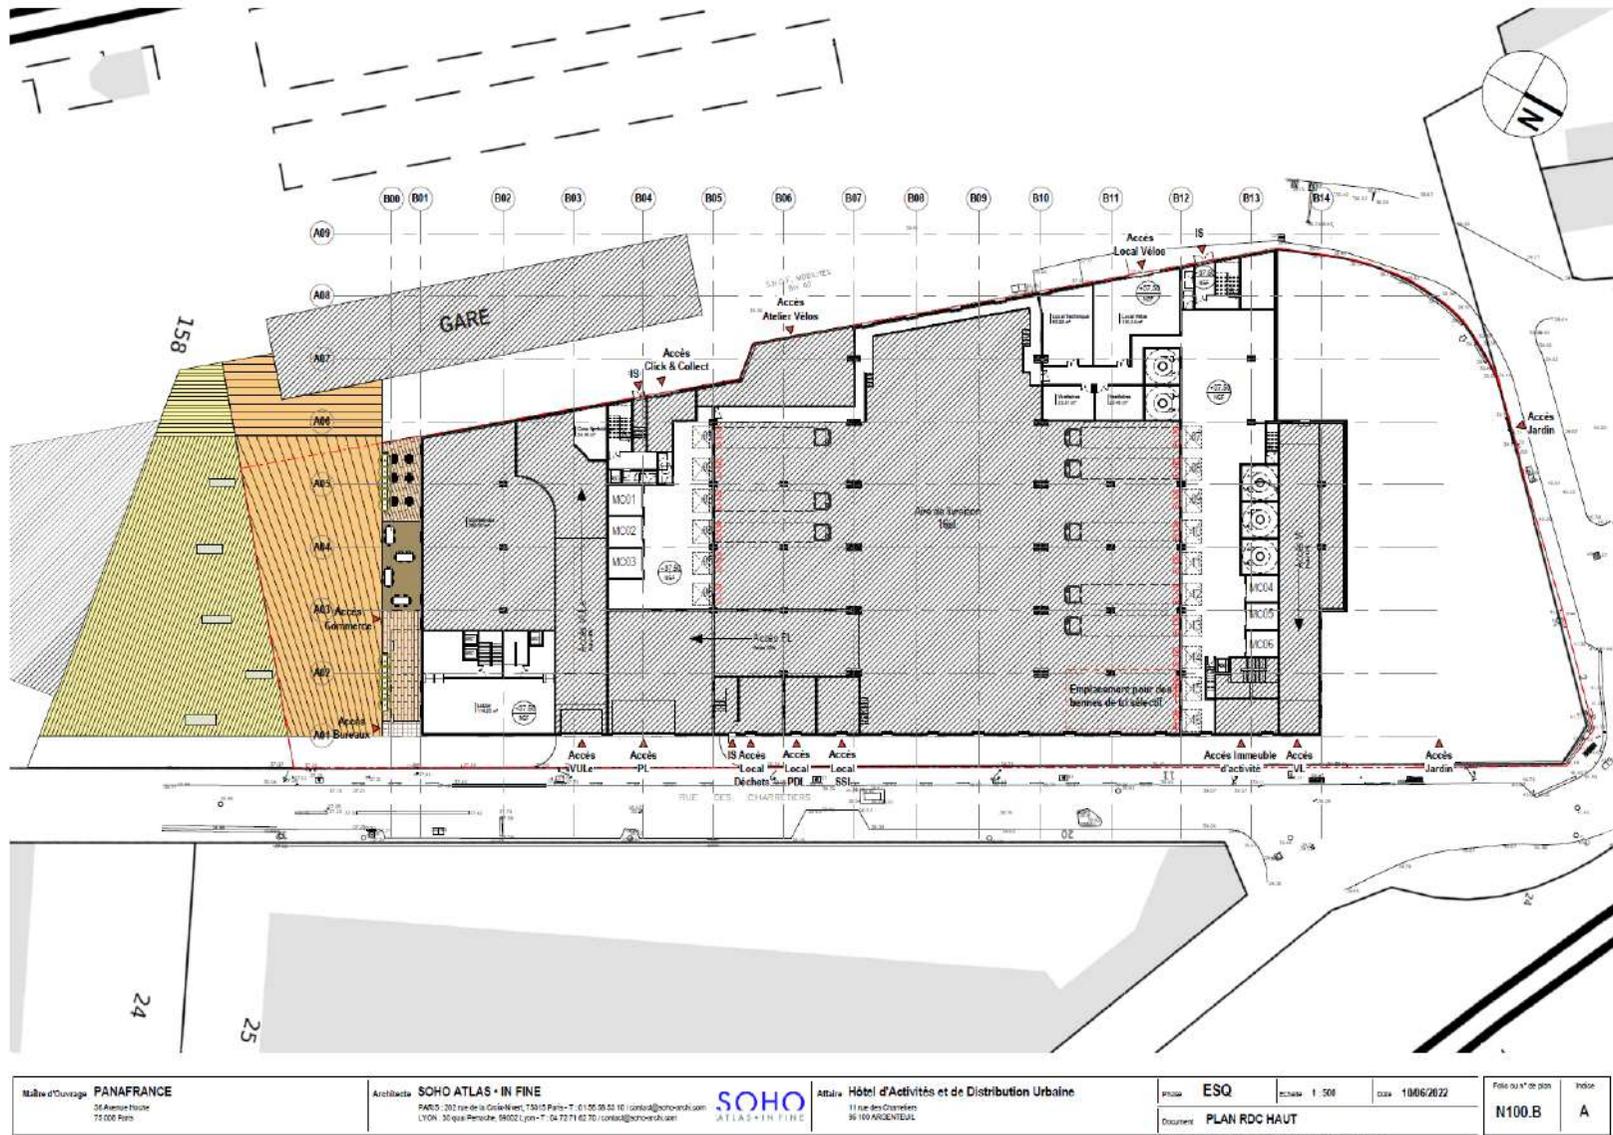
Plan de masse du RDC Haut (source : SOHO ATLAS IN FINE)
